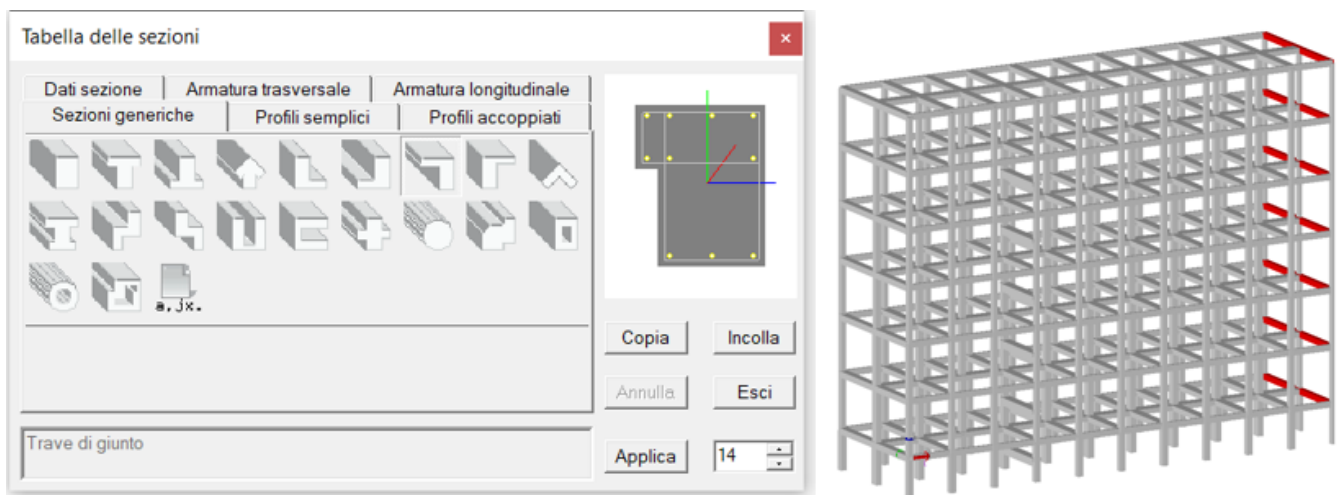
Modello US B1 - PROSAP, Archivio Sezioni, Proprietà n° 14 Trave di giunto, con inquadramento.
